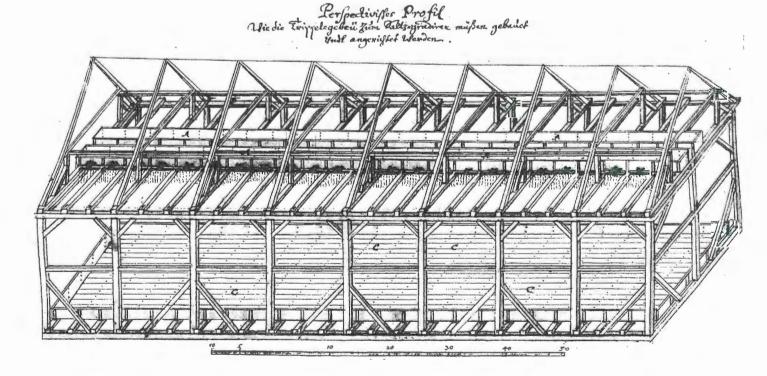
Plan des herzoglichen Baurats Paul Andrich zum Wiederaufbau der Saline Conow aus dem Jahre 1695
